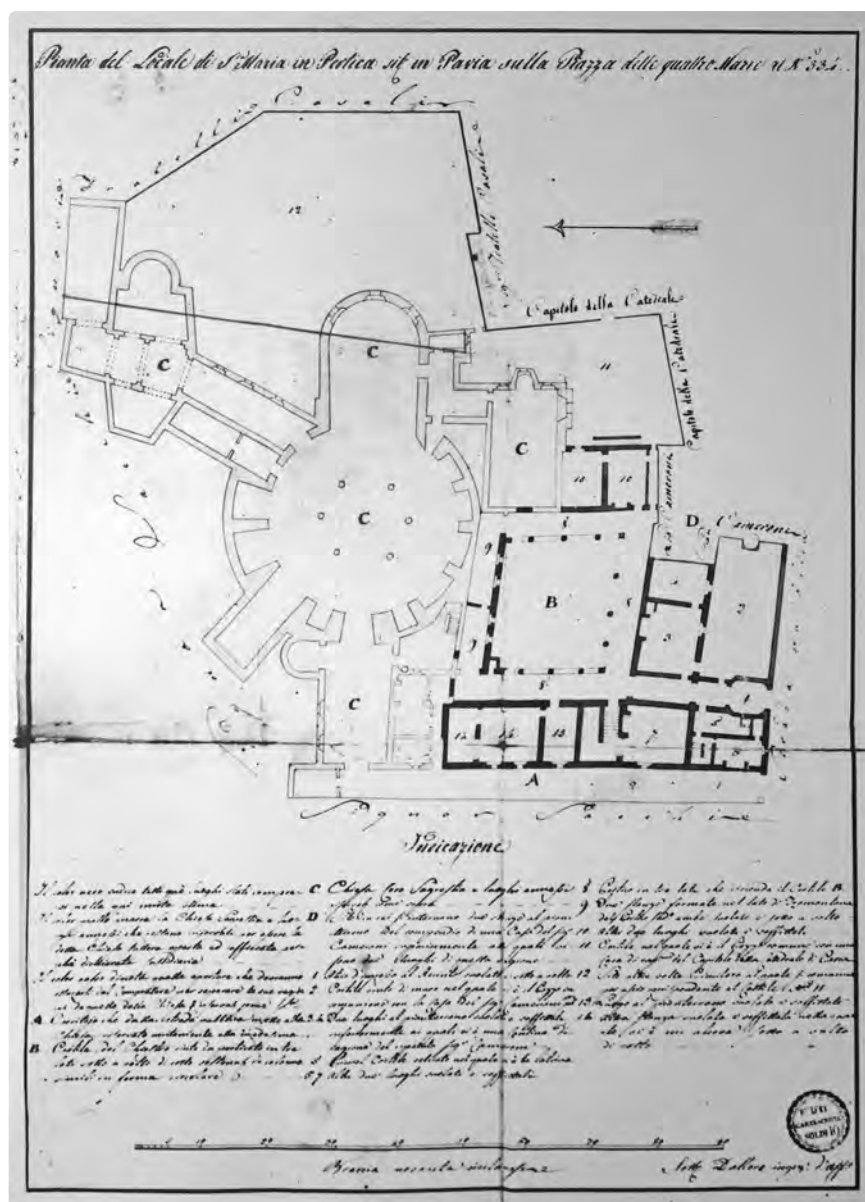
C. G. Dalloro, *Pianta del locale di Santa Maria in Pertica sito in Pavia...*; disegno a penna acquerellato, 1810. Pavia, Archivio Storico Civico (fondo U.T.C., cart. 100).
